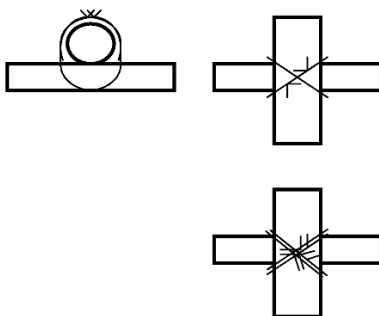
„Kreuzschlag“ horizontal liegender Stäbe
